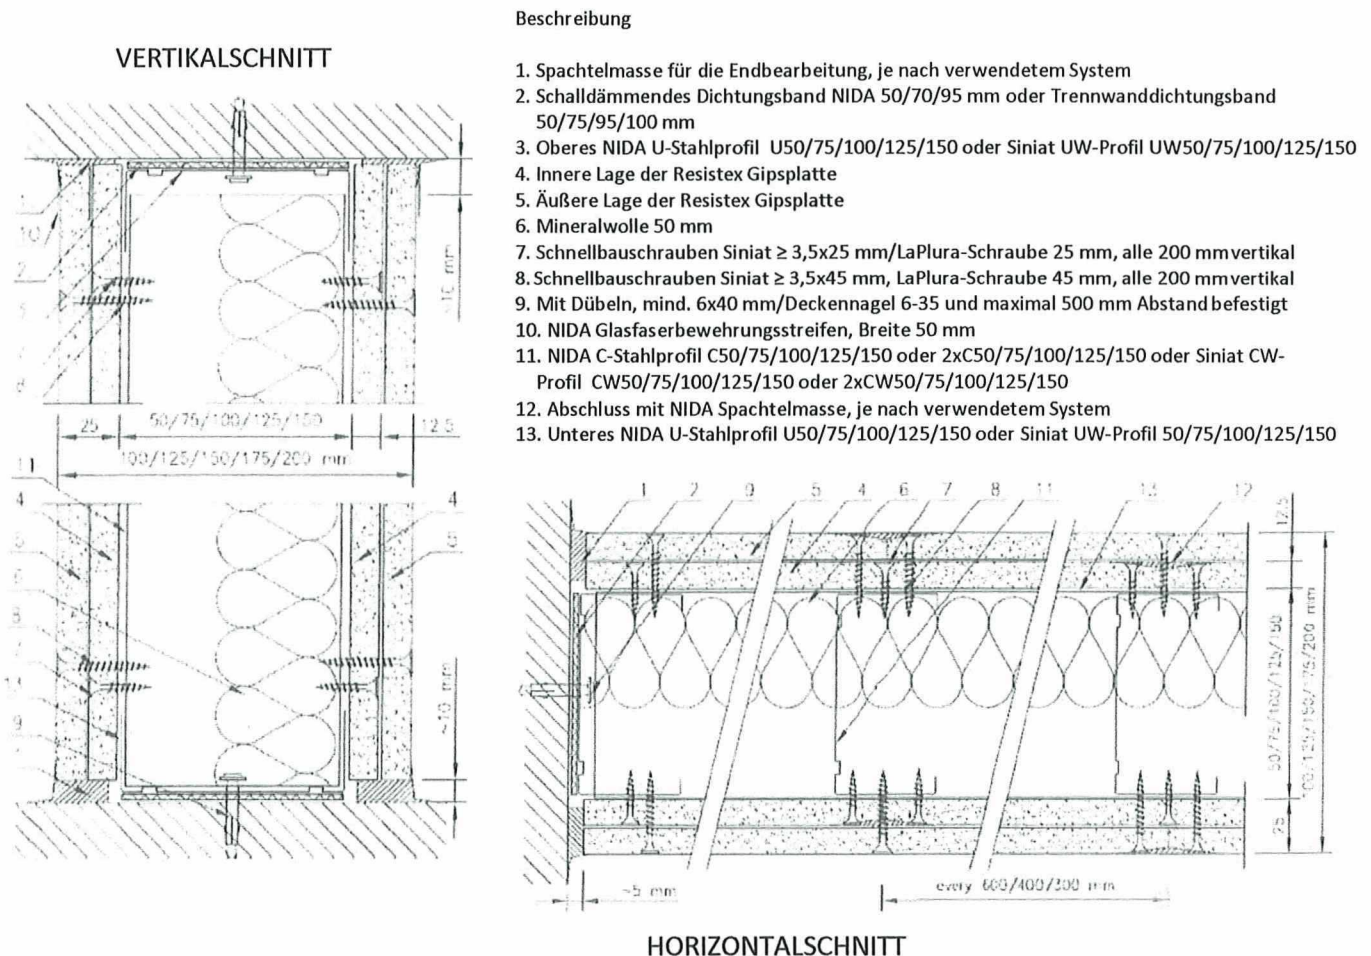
Vertikal- und Horizontalschnitt von einbruchshemmenden nichttragenden zweilagigen Trennwänden mit einfachem Ständerwerk
